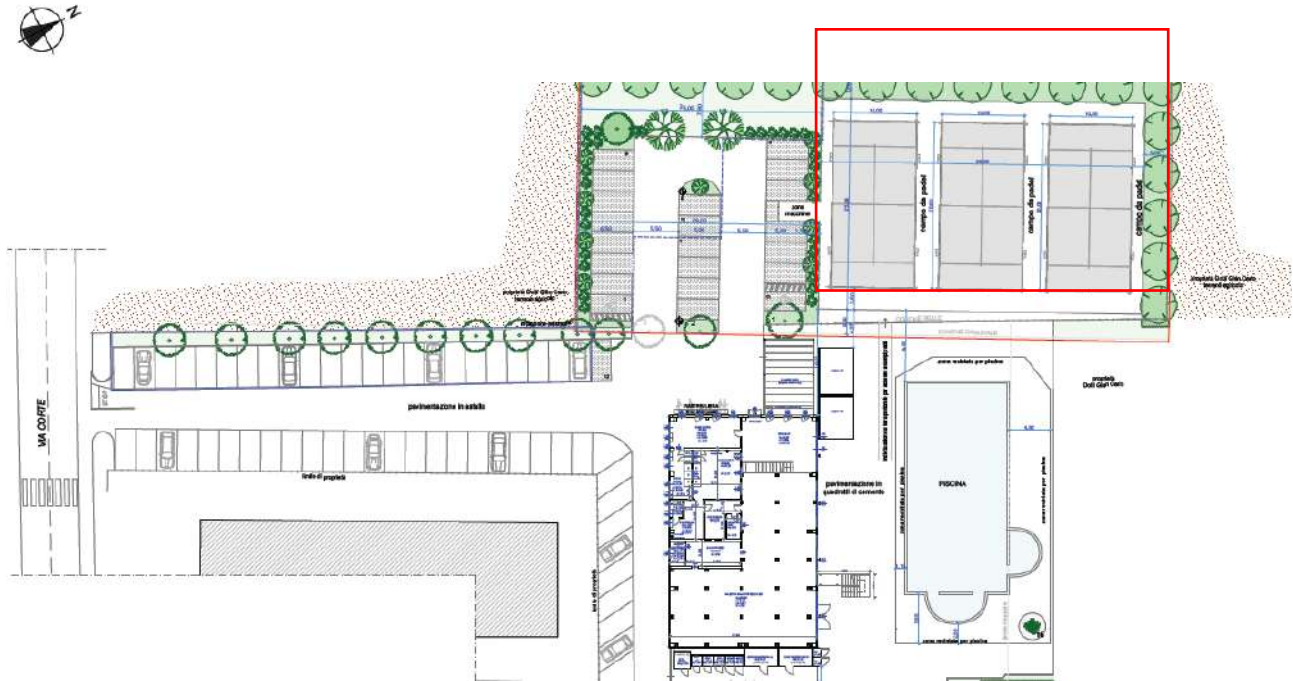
Planimetria di progetto, in rosso i campi da Padel previsti
